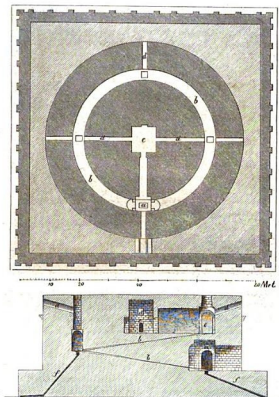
Grundriss und Durchschnitt des Mausoleum Hadrians.
